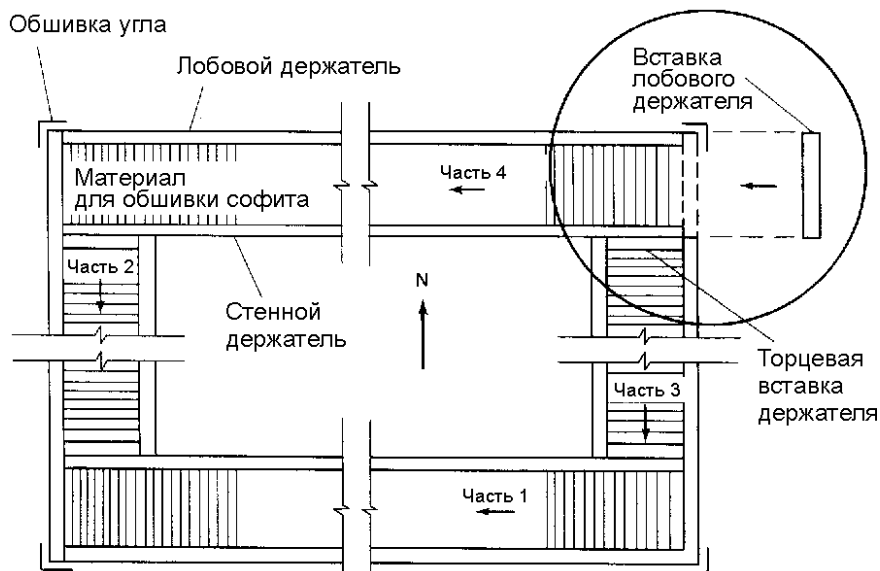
Порядок укладки алюминиевого софита для обшивки свесов вальмовой крыши по всему периметру (Reynolds Metals Products)
